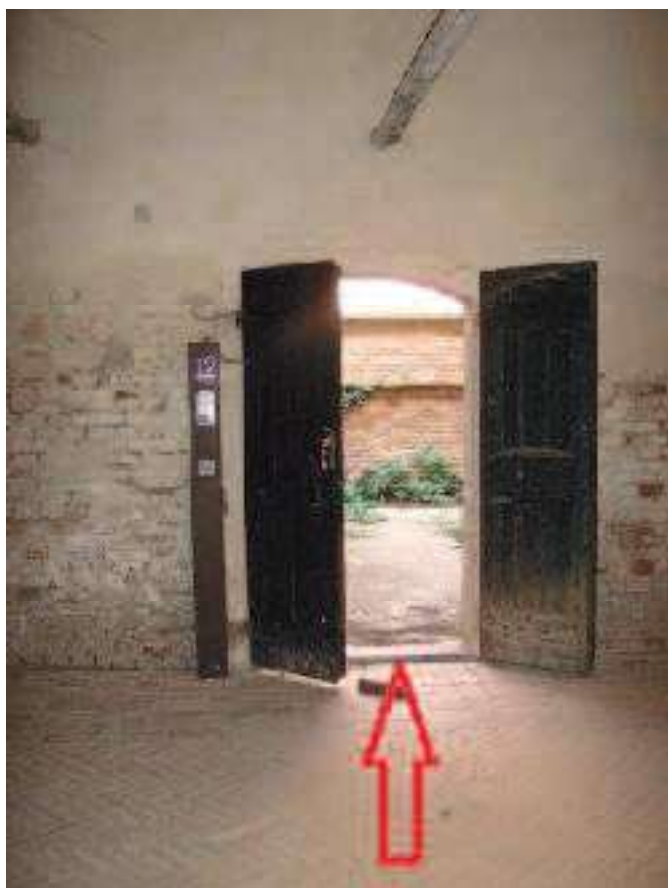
porta di accesso all'u.i. Sub.4 -lotto n.1 -
